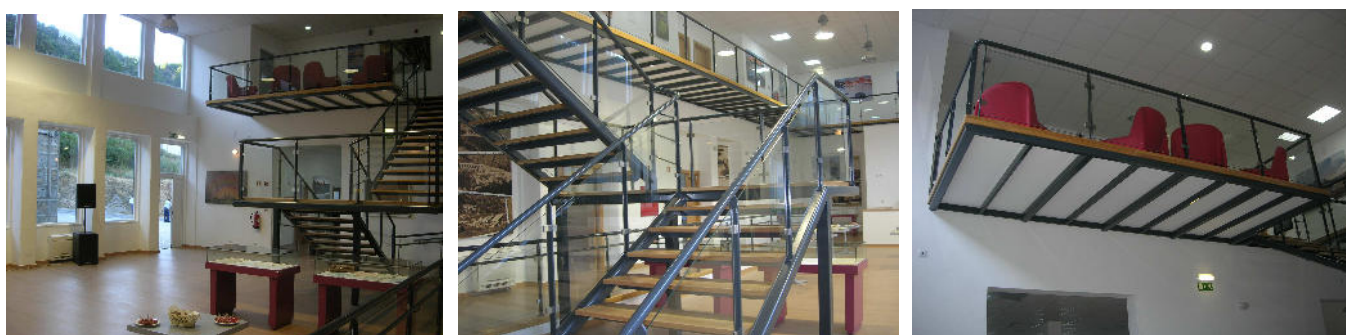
Escada metálica e varanda, obra concluída – “Ninho de empresas
